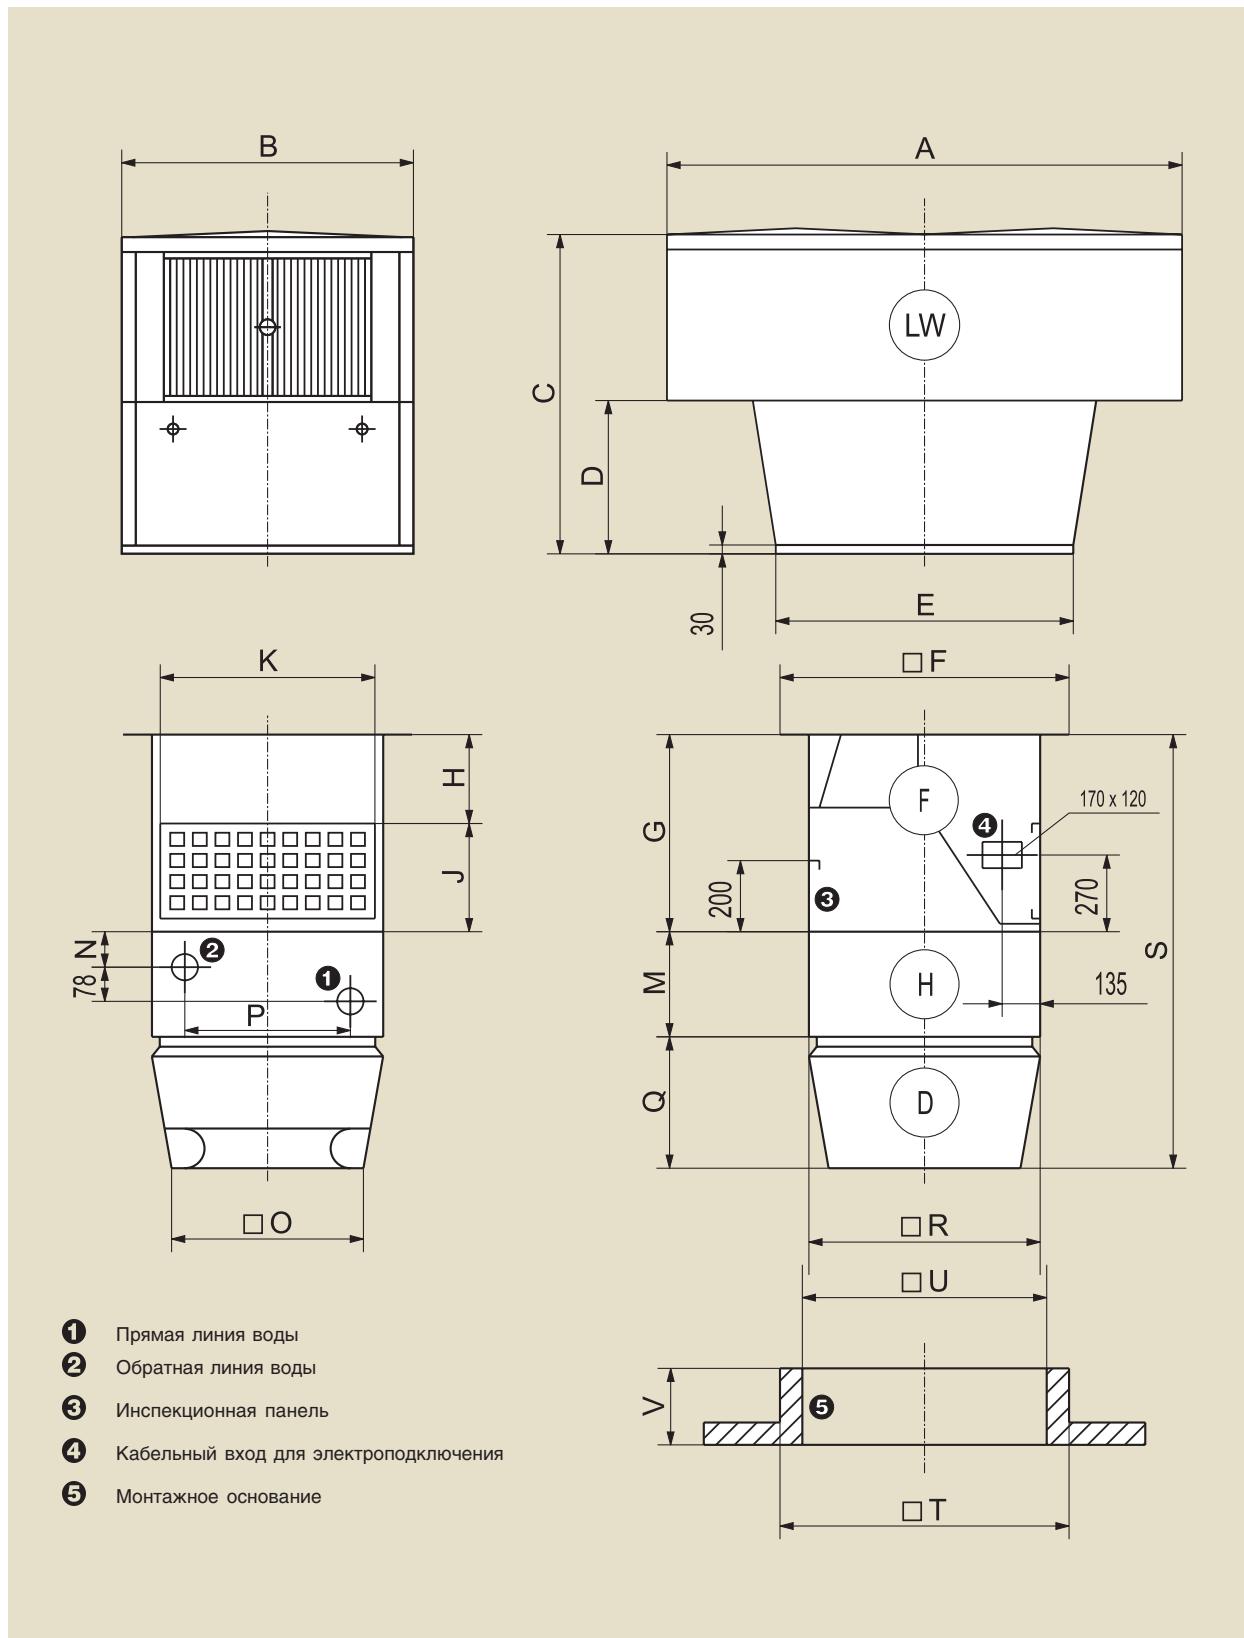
Габаритные и присоединительные размеры агрегатов LHW
